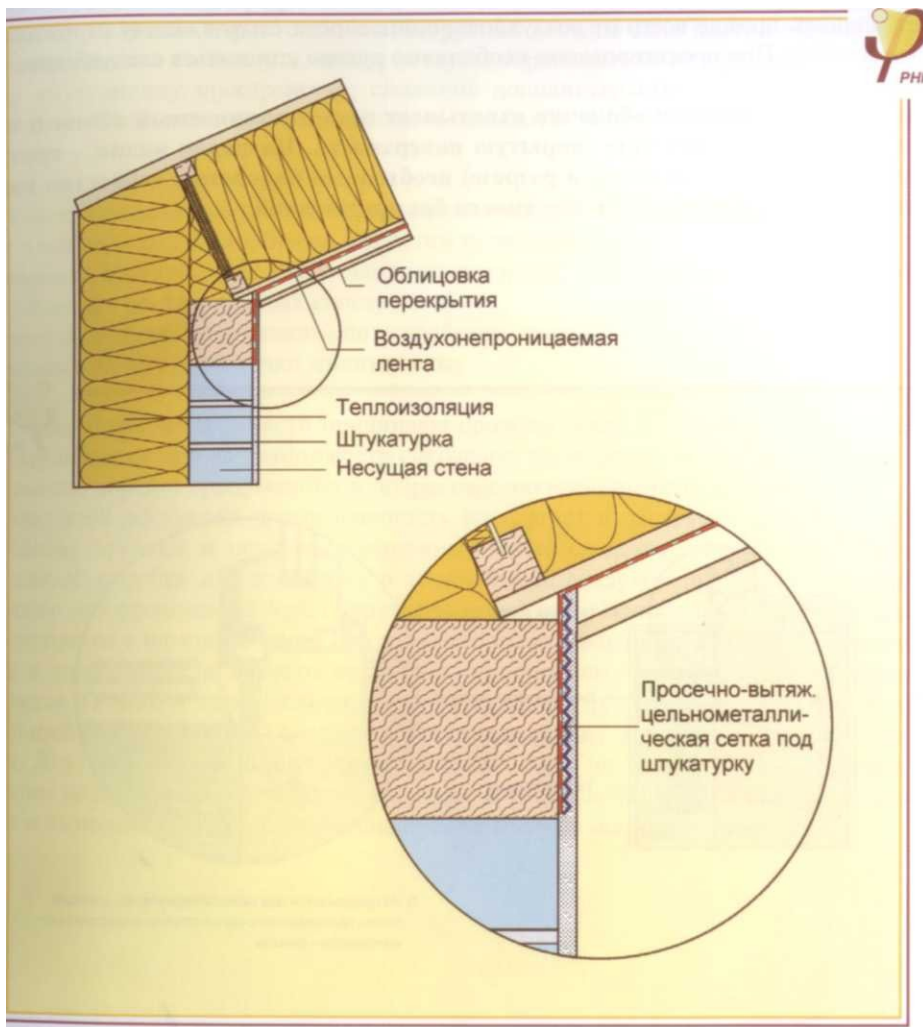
Воздухонепроницаемый стык легкой деревянной конструкции кровли с несущей оштукатуренной стеной. Узел легко решен в новом исполнении: пленка сначала укладывается с выступом 8...20 см на несущую стену. Поверх пленки к стене крепится просечно-вытяжная цельнометаллическая сетка под штукатурку. Далее сетка и пленка полностью покрываются штукатуркой. Так возникает надежный герметичный стык
